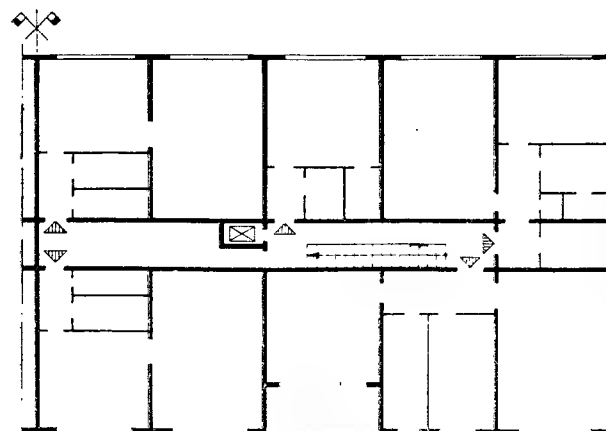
Forma în plan a clădirilor cu structura de rezistență din diafragme de beton armat monolit :
